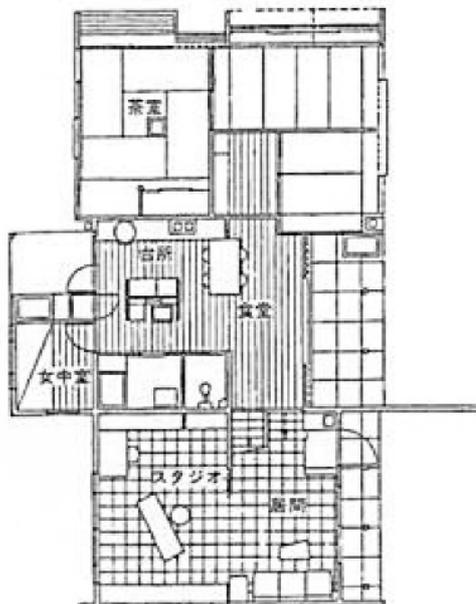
『国際建築』掲載の「秦邸」(1953) 平面図
